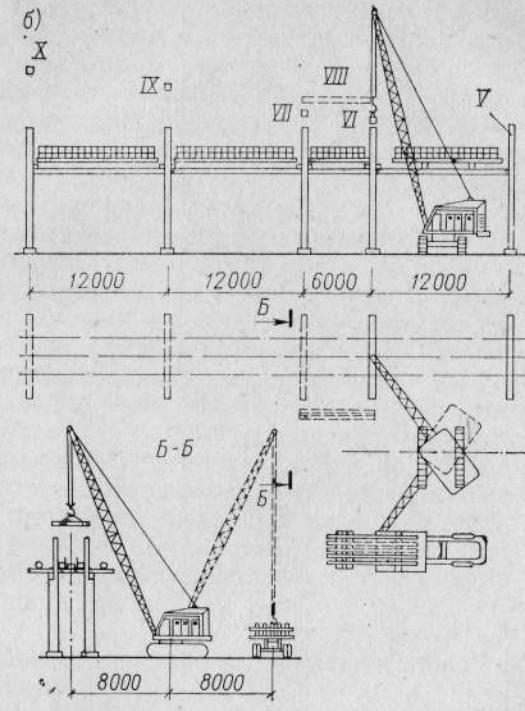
Схема монтажа одним краном комбинированных блоков железобетонной балочной двухъярусной эстакады
